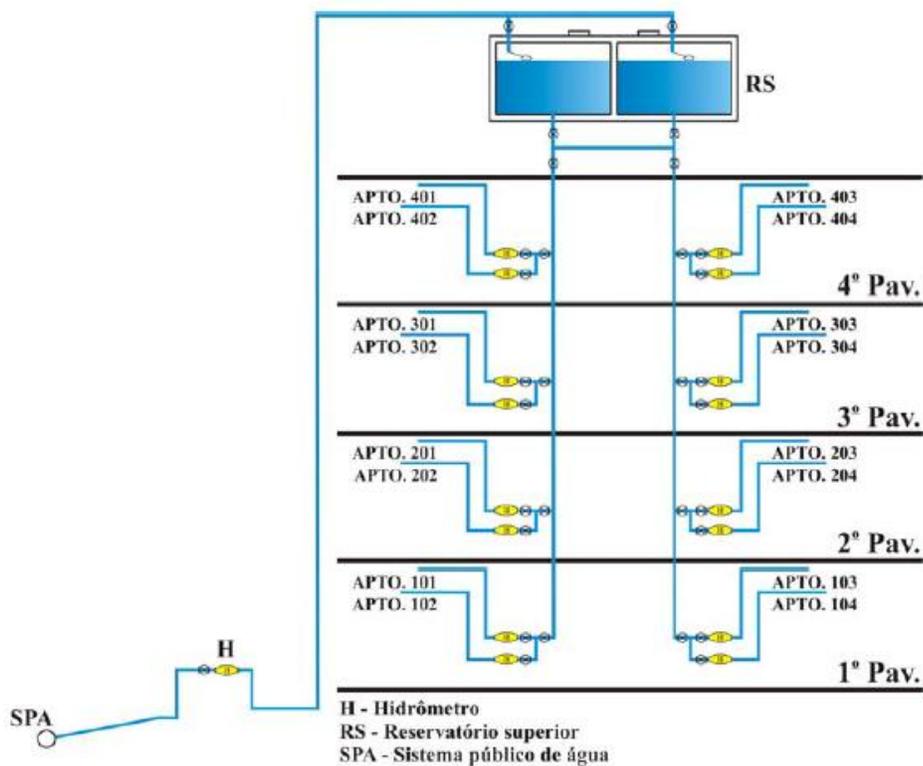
Medidores nos halls dos pavimentos (PERES, 2006).
